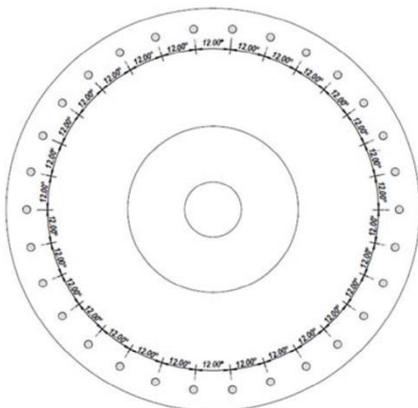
Andamento geometrico della fondazione (pianta – non in scala).
